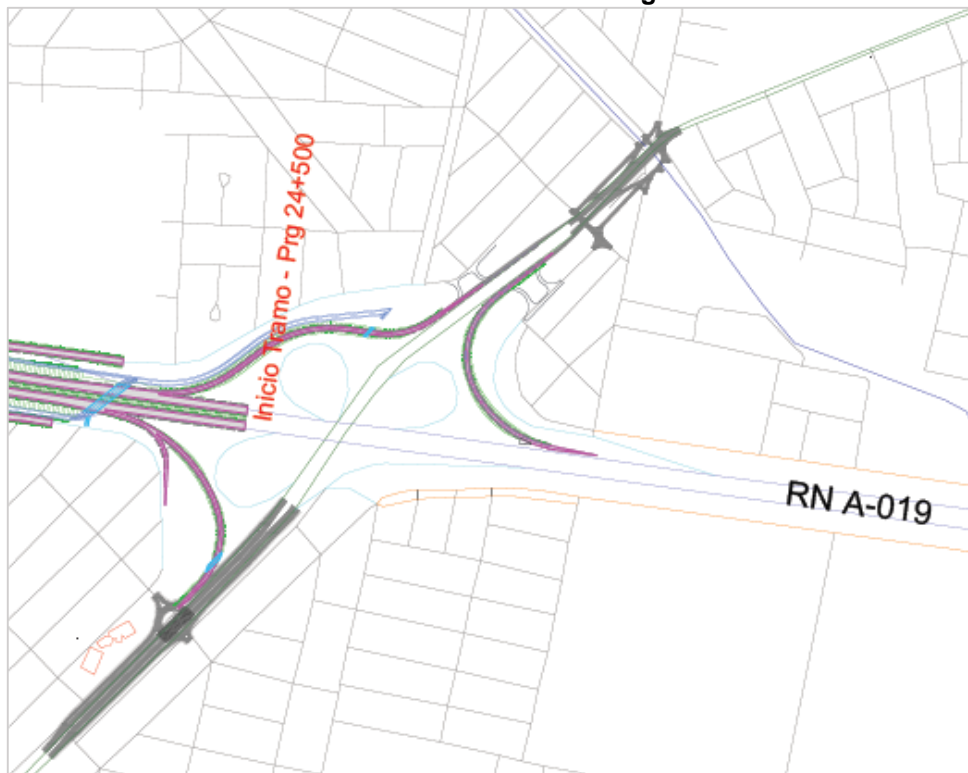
Paso a Nivel Ferrocarril Ramal – Acceso Planta Renault
